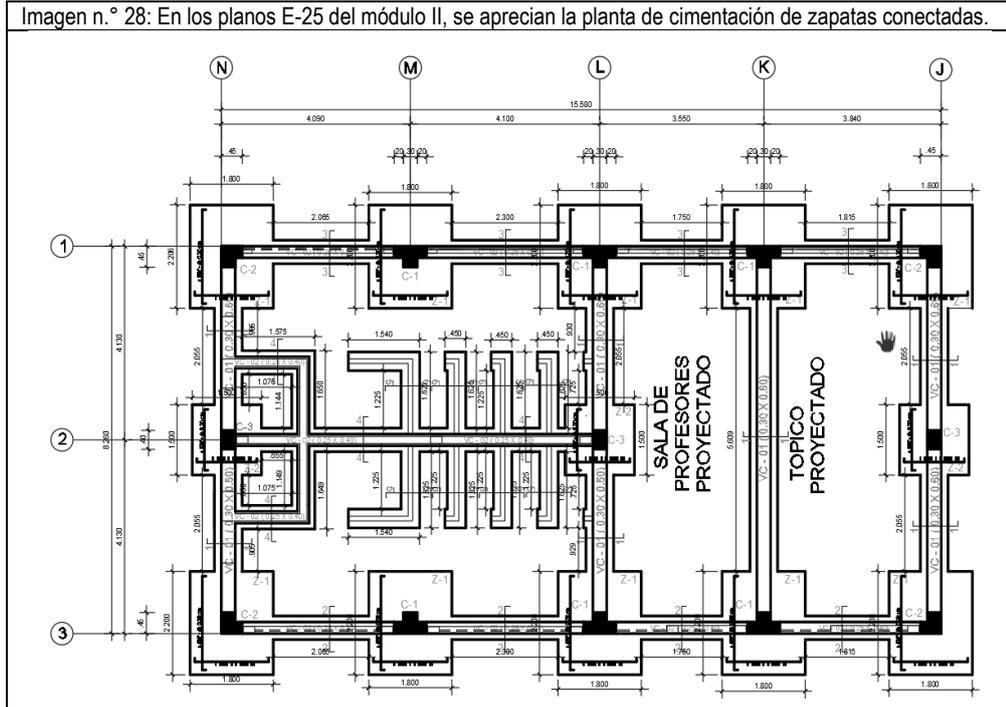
En los planos E-25 del módulo II, se aprecian la planta de cimentación de zapatas conectadas.
